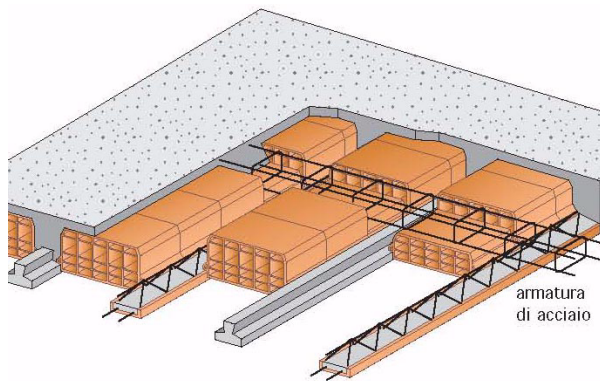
In Italien häufig verwendetes Deckensystem aus vorfabrizierten kleinen bewehrten Betonbalken, Ziegeln, Bewehrungskörben und Ortbetonüberdeckung [Bac09] (Solaio in latero-cemento, wird im Bericht als SLC-Deckensystem bezeichnet)
